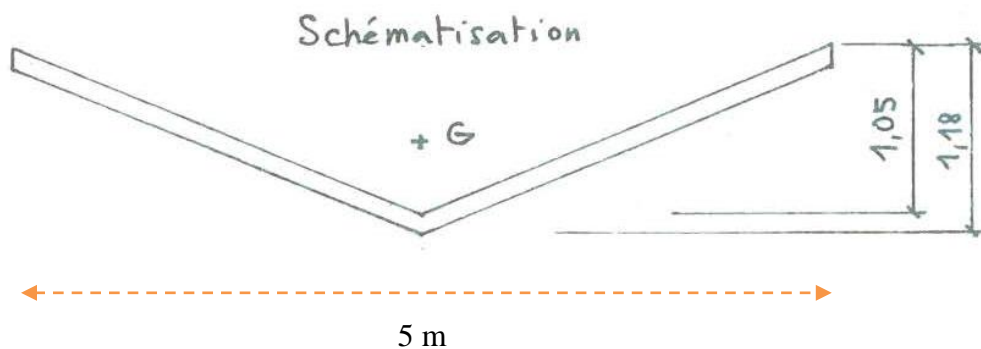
Section d'une onde de la couverture plissée en rive
